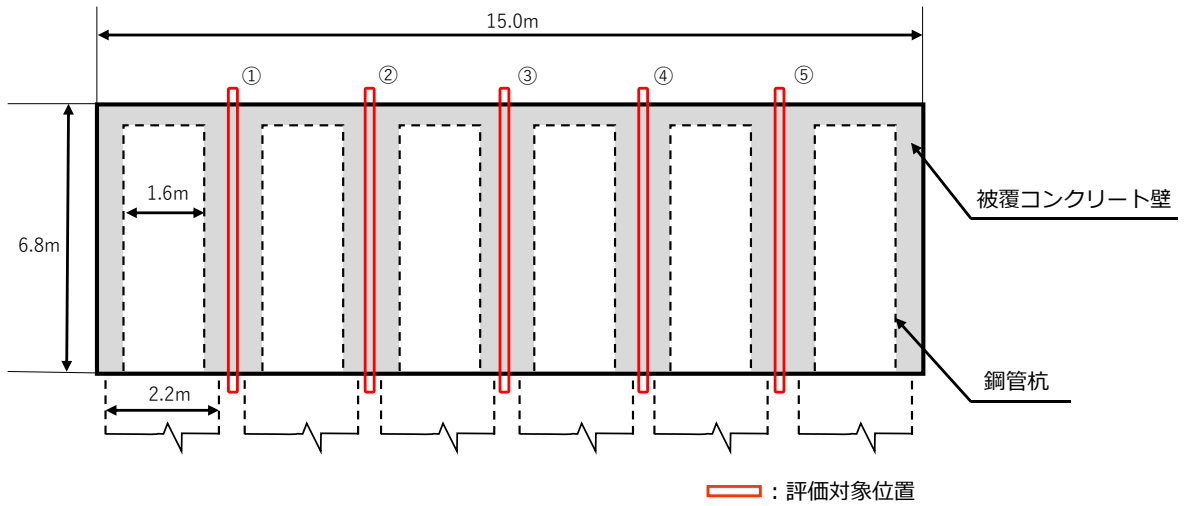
(3) 評価対象位置図 (②-②断面 正面図)
